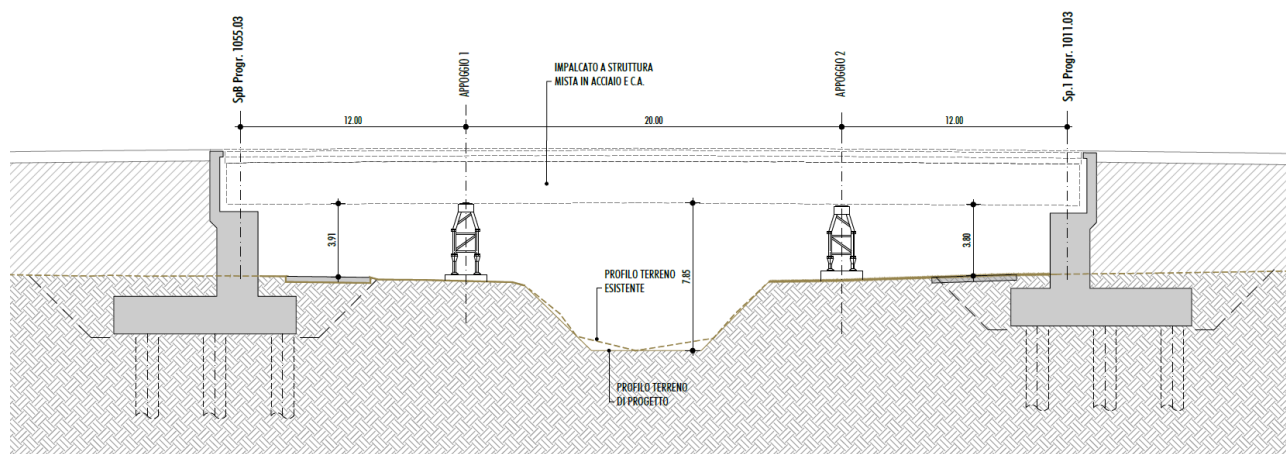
SEZIONE IN ASSE STRADA (VISTA DA MONTE) DURANTE LA FASE DI CANTIERE CON GLI APPOGGI PROVVISORI
